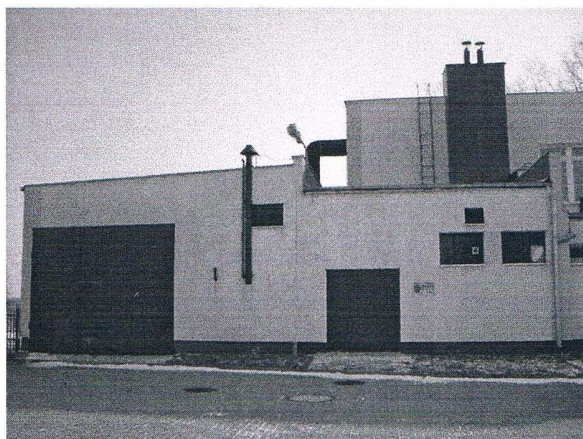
Widok elewacji wschodniej łącznika do Sali gimnastycznej
